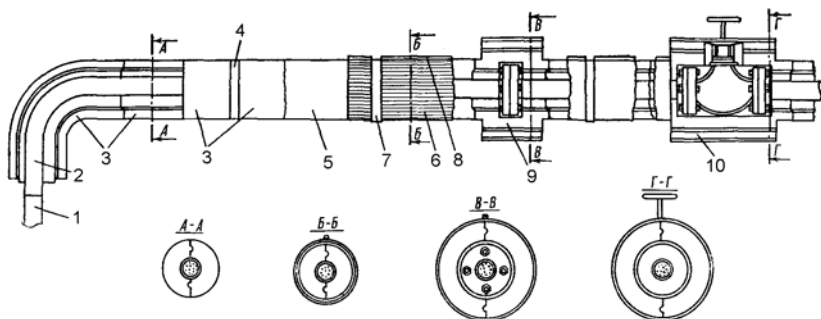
Изоляция трубопровода скорлупами из ПСВ-С: 1 – холодильный трубопровод; 2 – труба, покрытая мастикой ЭГИК; 3 – изоляционные элементы трубы – скорлупа из ПСВ-С; 4 – крепежная лента ПЭ или ПВХ (липкая); 5 – покрытие изоляции (мастика ЭГИК); 6 – покрытие изоляции (фольгоизол); 7 – покрытие стыка – полоса фольгоизола; 8 – замок покрытия; 9 – фланцевая скорлупа; 10 – изоляционный элемент вентиля (скорлупа)
